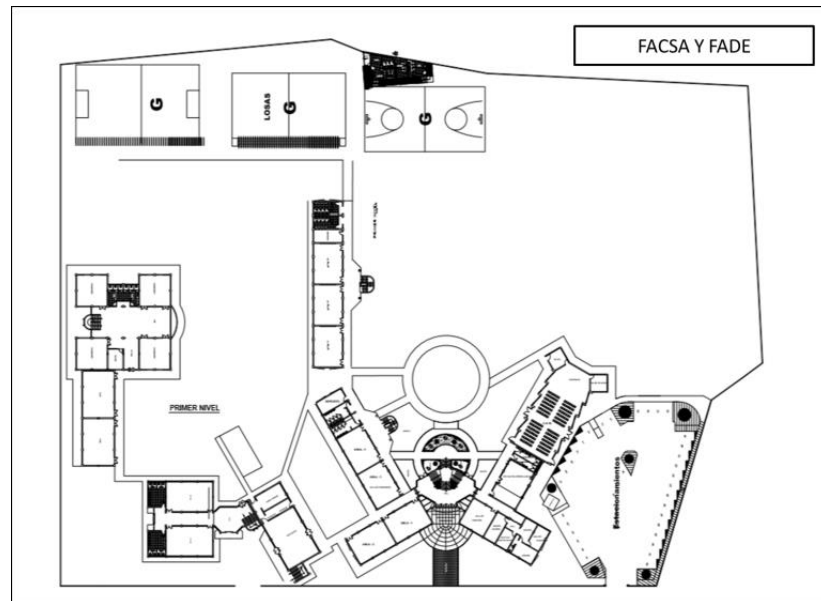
Primera Planta de las Facultades de Salud y Derecho - UPT
